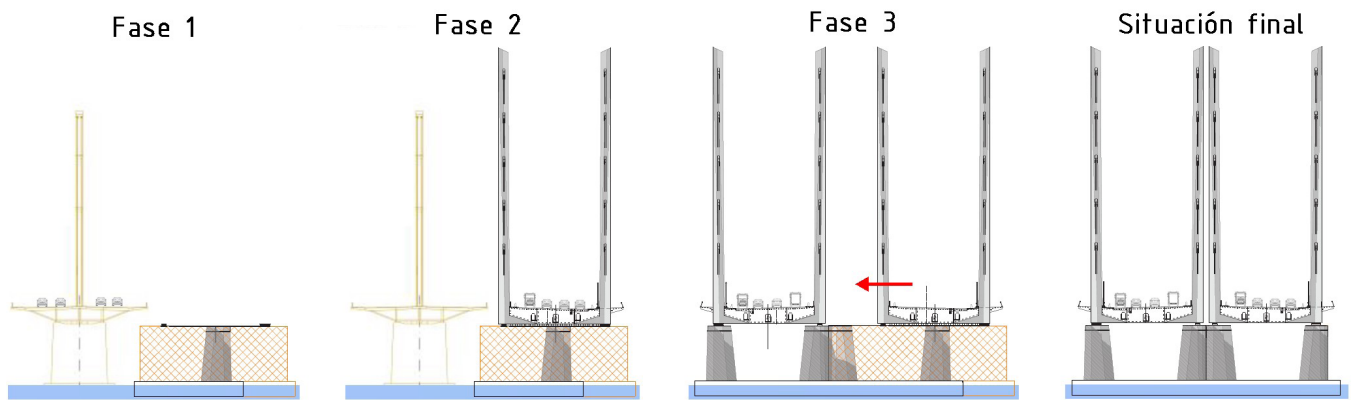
Proceso constructivo: ripado transversal del puente completo (LAP).
